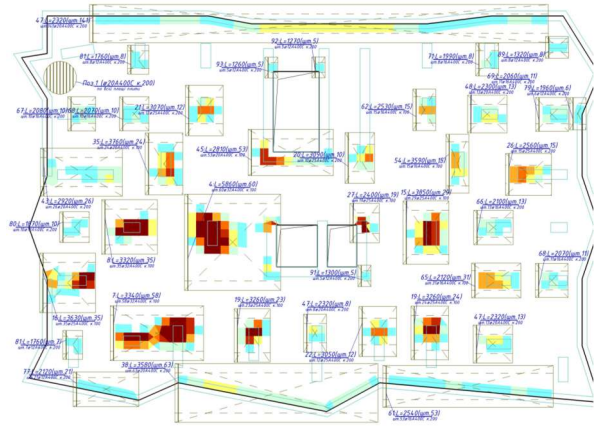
Армуння плити перекриття верхньої арматури вздовж осі Y
